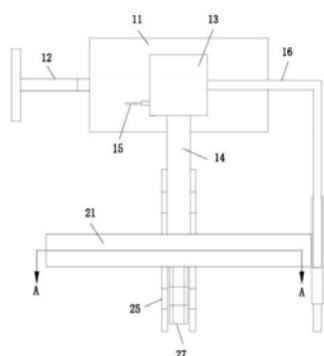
是水利工程基坑管井填埋施工方法的俯视平面结构示意图
